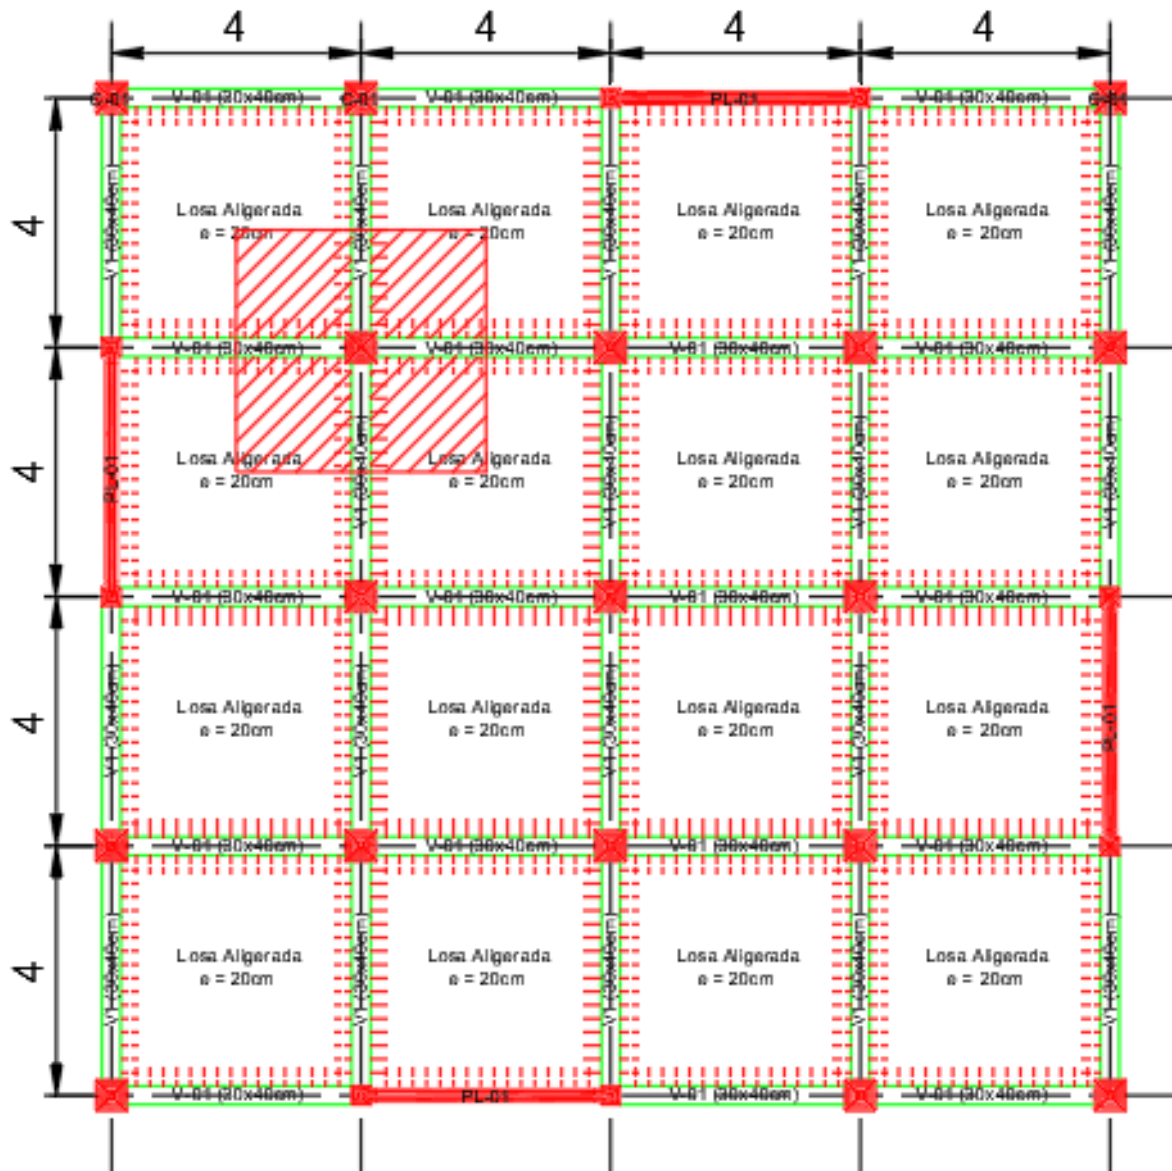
Área tributaria de la columna en planta en AUTOCAD versión 2020.
